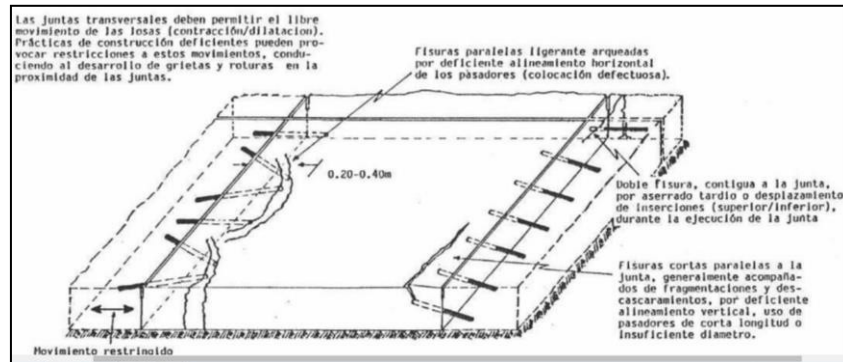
Falla por mal funcionamiento de juntas de Pavimento Rígido
